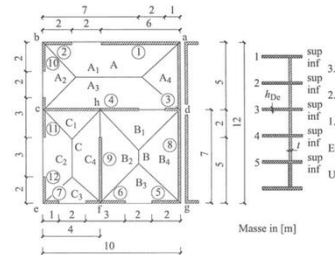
Wohnungsgrundriss bzw. Schnitt mit Tragwänden
